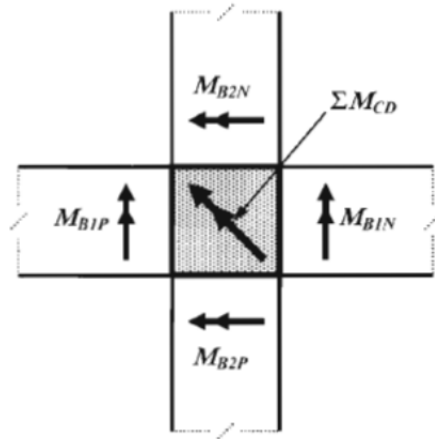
14. Planta de nudo de columna interior sometido a momento bidireccional. (Priestley, 2007)
